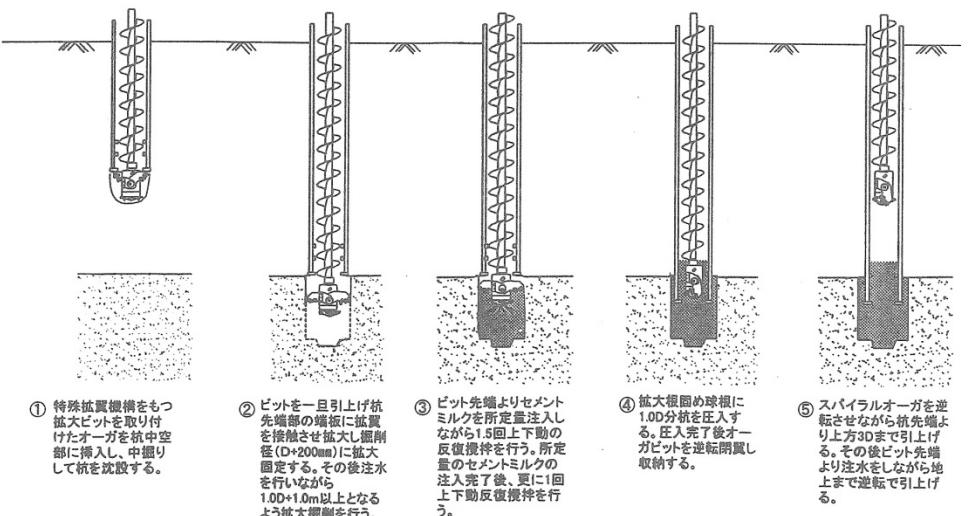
(a) T B S 工法(RPタイプ)の施工手順
